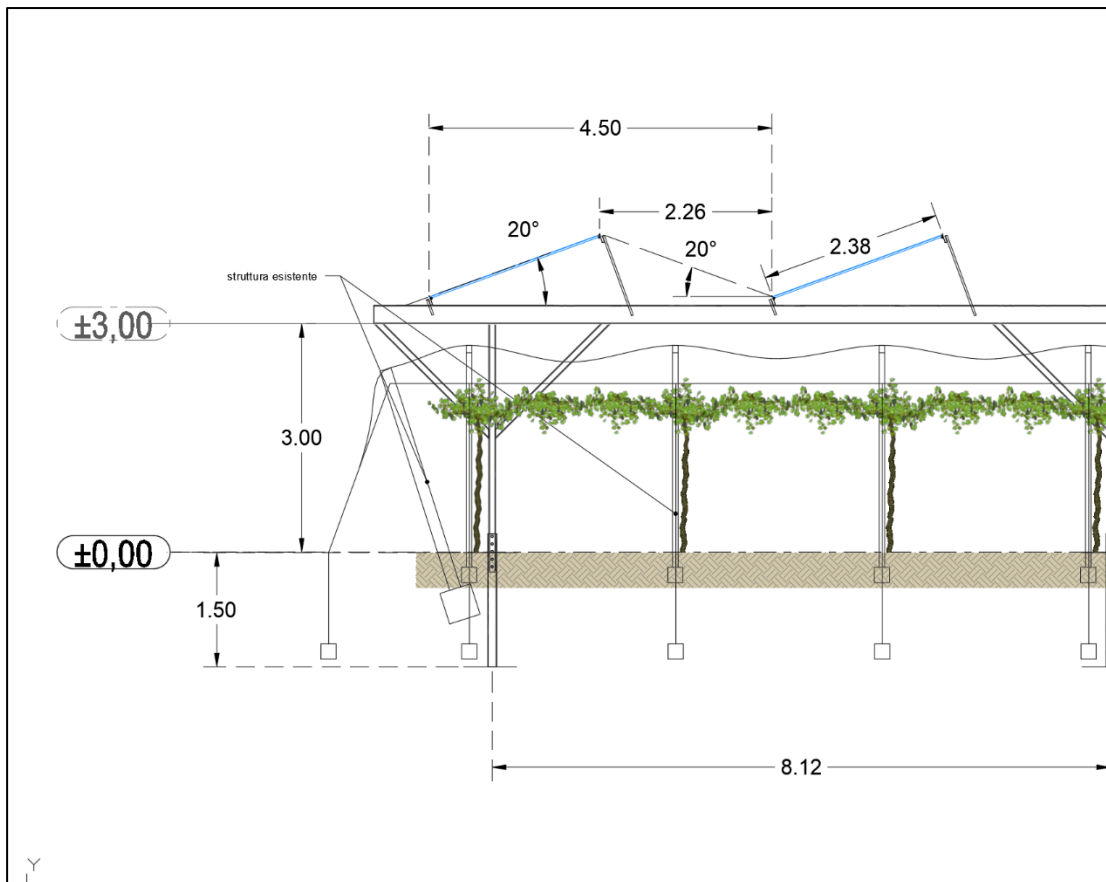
Particolare costruttivo sezione trasversale tipologica strutture fisse di supporto con le dimensioni fuori scala.
